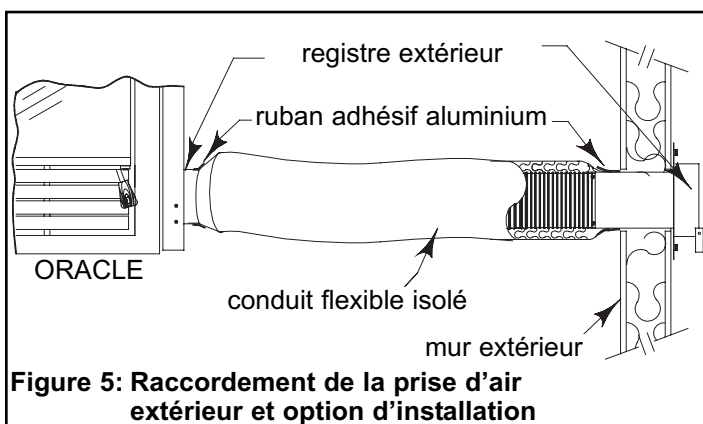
Raccordement de la prise d'air extérieur et option d'installation
